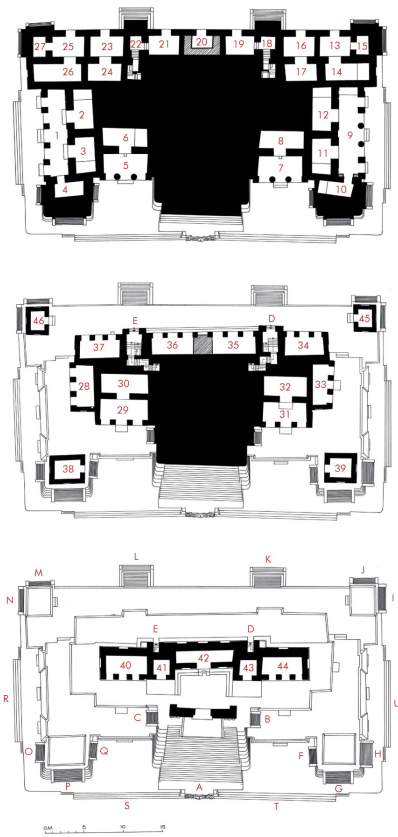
Plantas del Palacio de Santa Rosa Xtampak tomadas de H. Hohmann (2017, p. 20).
